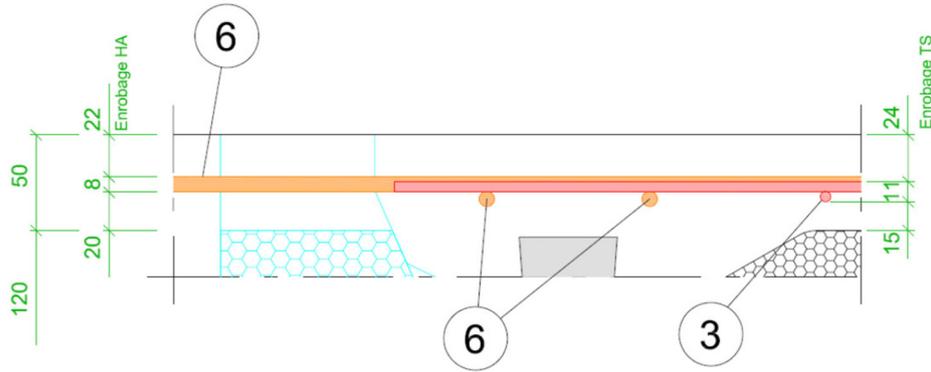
Vue de coupe – Ferrailage transversal (exemple)
